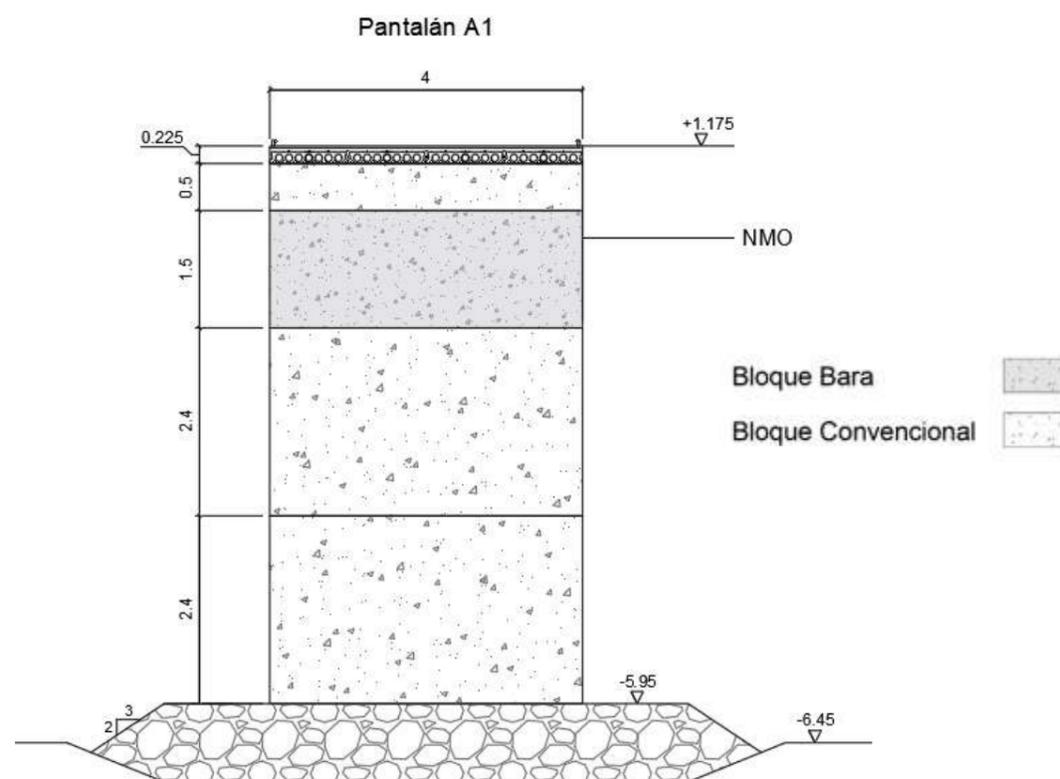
Sección transversal pantalán A1. Fuente: Elaboración propia.
